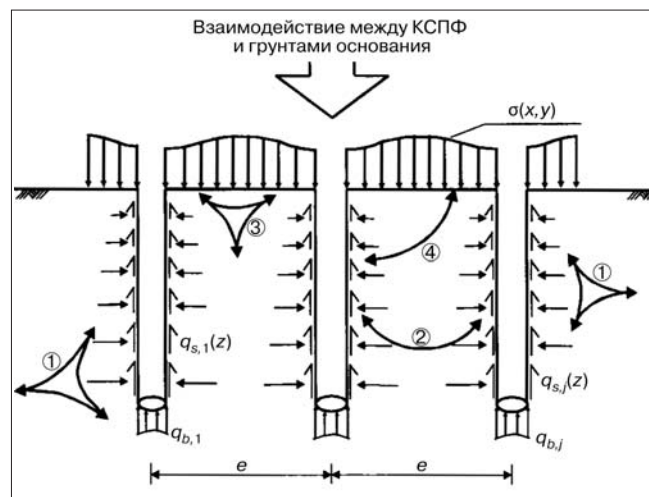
Определяющие взаимодействия грунт – несущая конструкция КСПФ: 1 – между сваями и грунтом основания; 2 – между сваями в группе; 3 – между фундаментной плитой и грунтом основания; 4 – между сваями и фундаментной плитой
